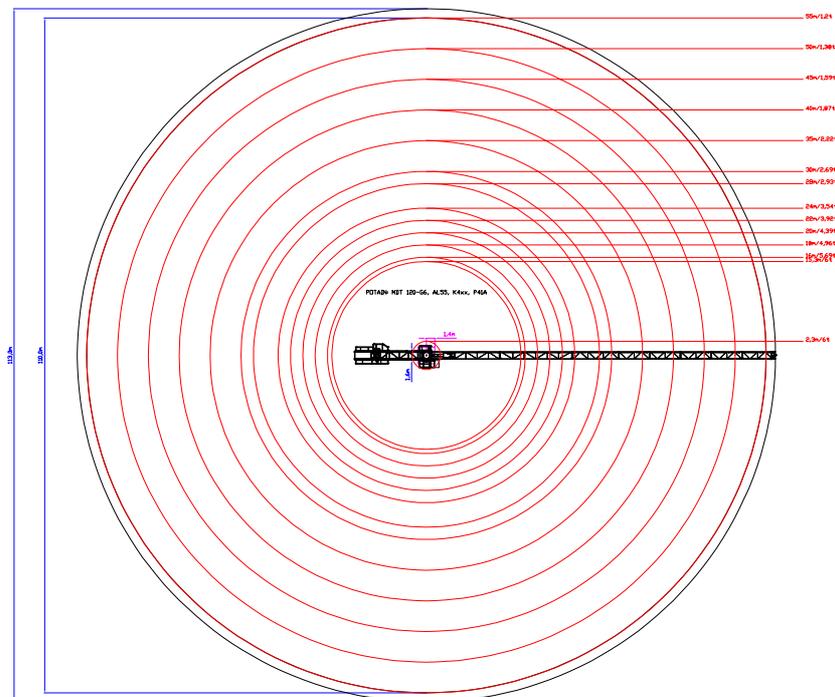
Oben drehender Katzausleger in der Draufsicht
